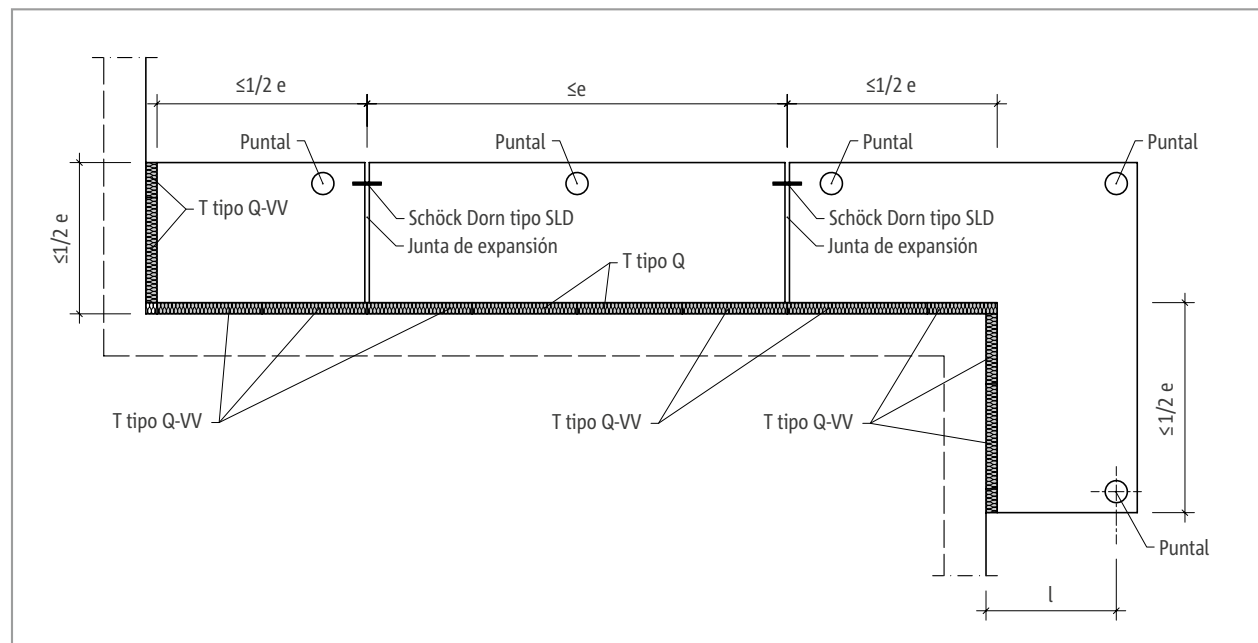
Schöck Isokorb® T tipo Q, Q-VV: Disposición de las juntas de expansión
